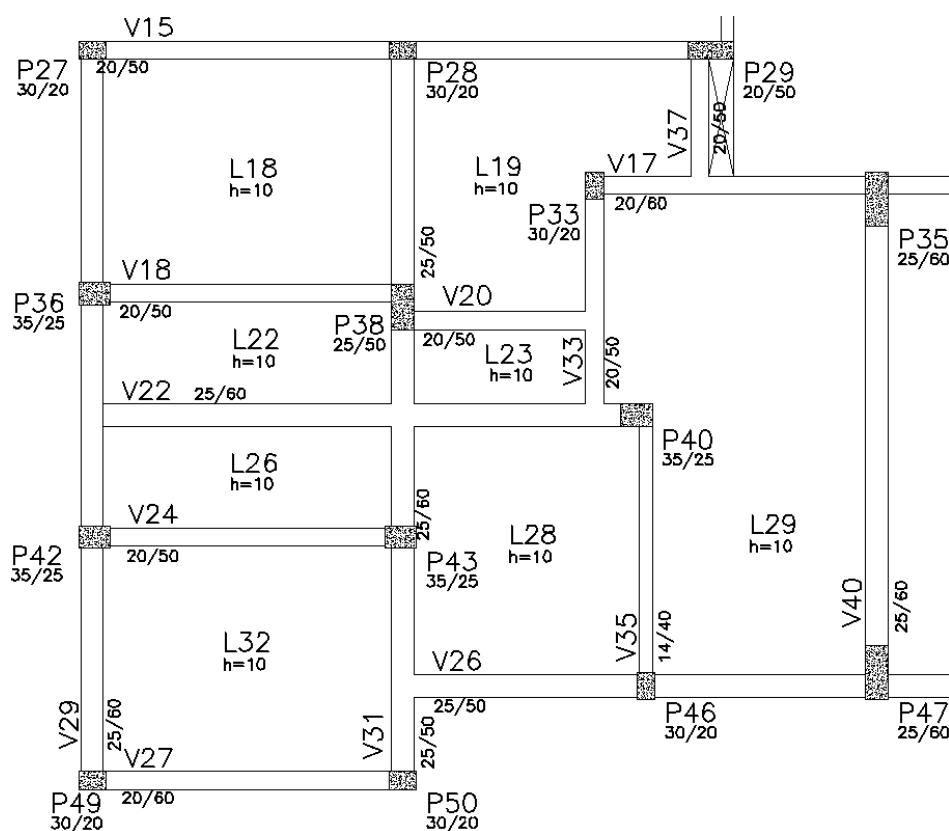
Estrutura de transição no trecho do apartamento modelado.
